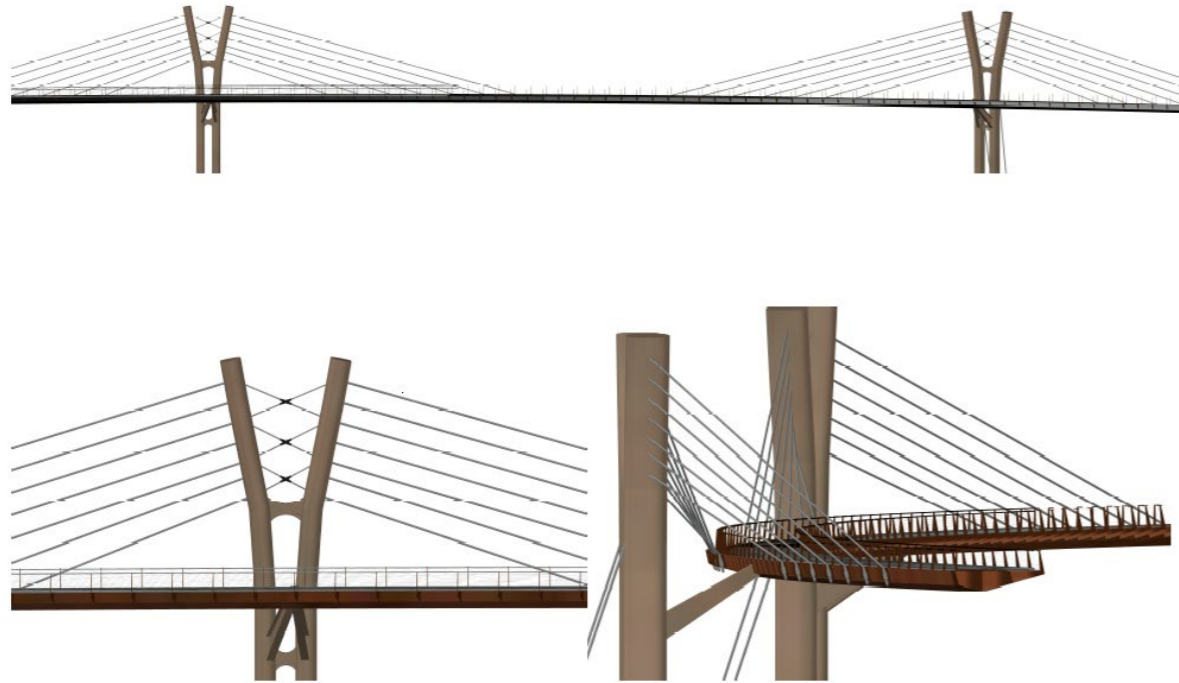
Vista 3D de la pasarela con los tirantes adoptados y el tablero. Fuente: Elaboración Propia (AutoCAD)
